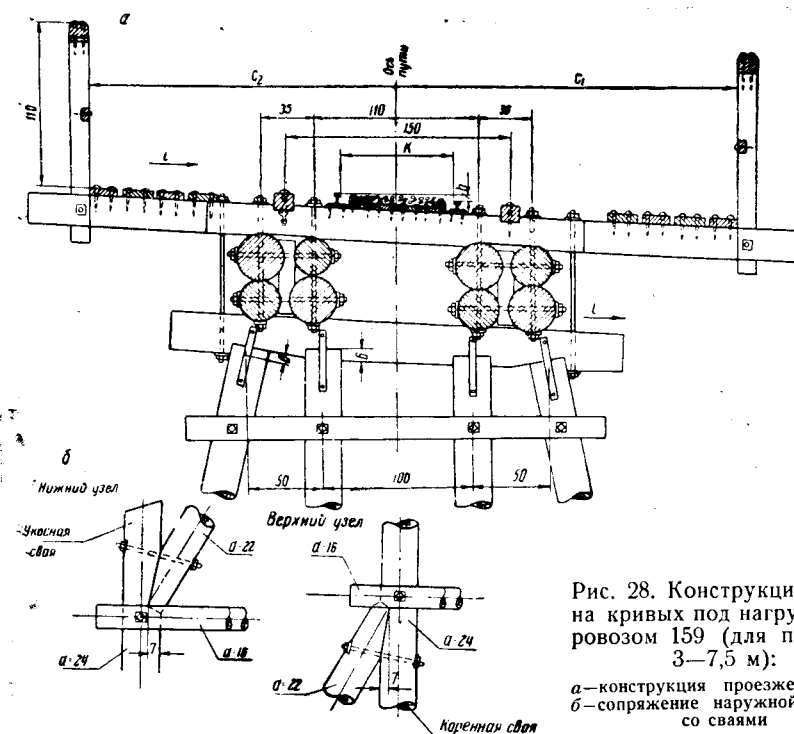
Конструкция моста на кривых под нагрузку паровозом 159 (для пролетов 3—7,5 м):
